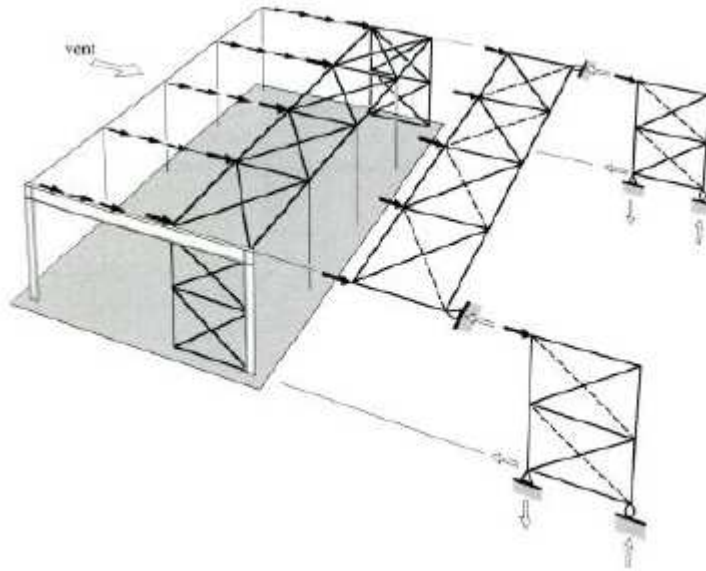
Cheminement des forces transversales dans le cas d'une structure à toiture horizontale.
